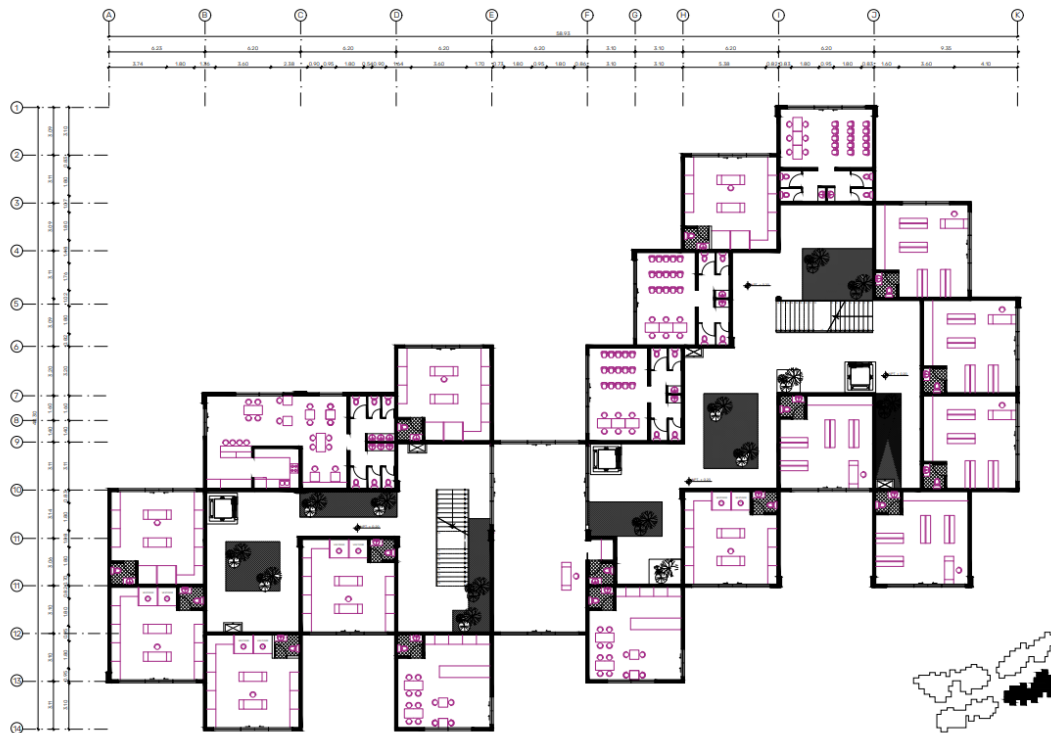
Planta Baja Bloque 1. Elaboración propia 2023
